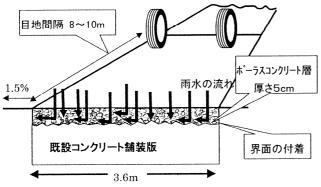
既設コンクリート舗装を対象とした付着型ポーラスコンクリートオーバーレイ
